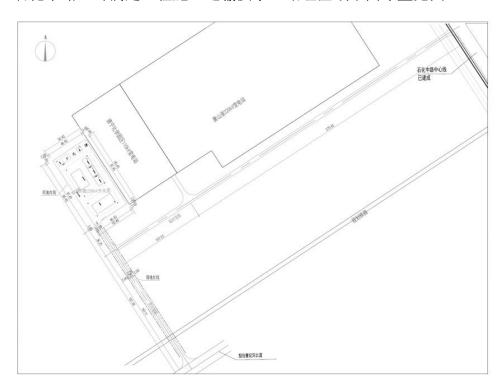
曹妃甸开关站站址区域平面布置示意图
